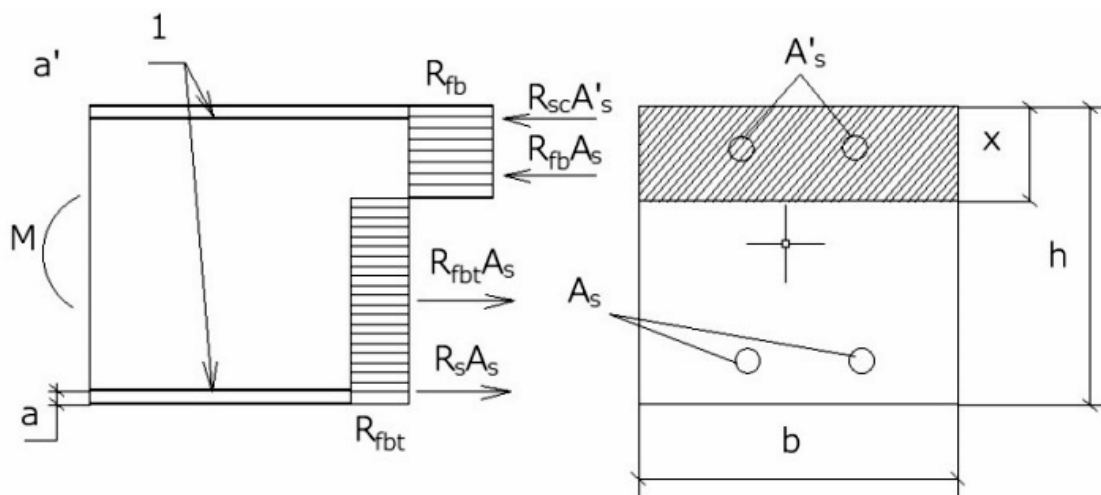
Эпюра напряжений и схема приложения нагрузки в расчетном сечении изгибаемой фибробетонной балки, при расчете по прочности (при комбинированном армировании) [2]
